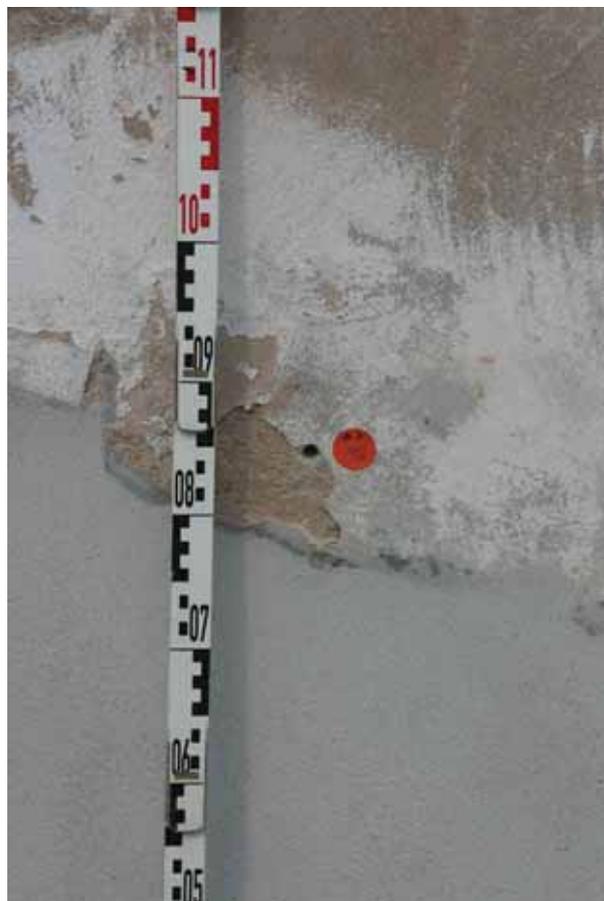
Beamtenhaus, Südwestfassade, M_K_TP2
